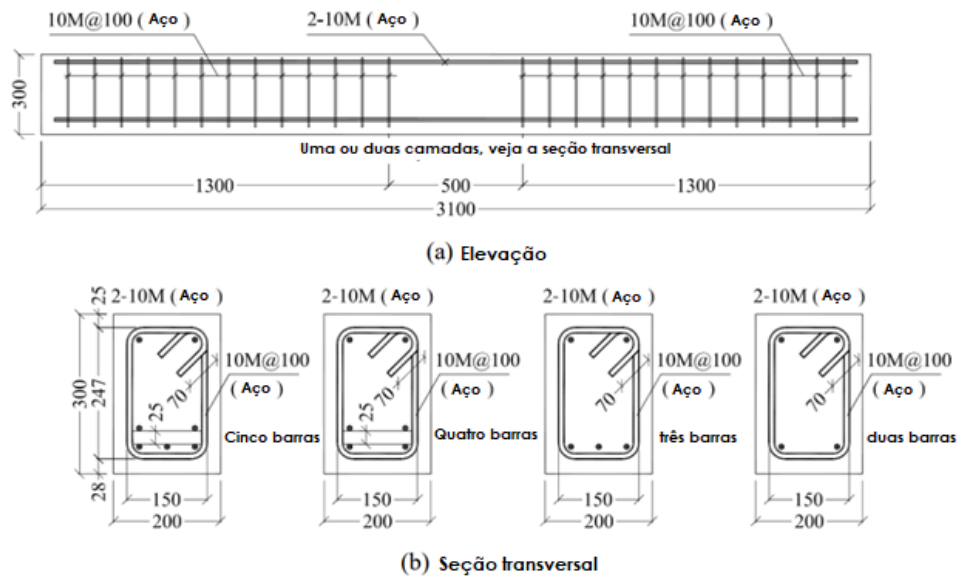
Dimensões e detalhes das armaduras ensaiadas – adaptada [10]
